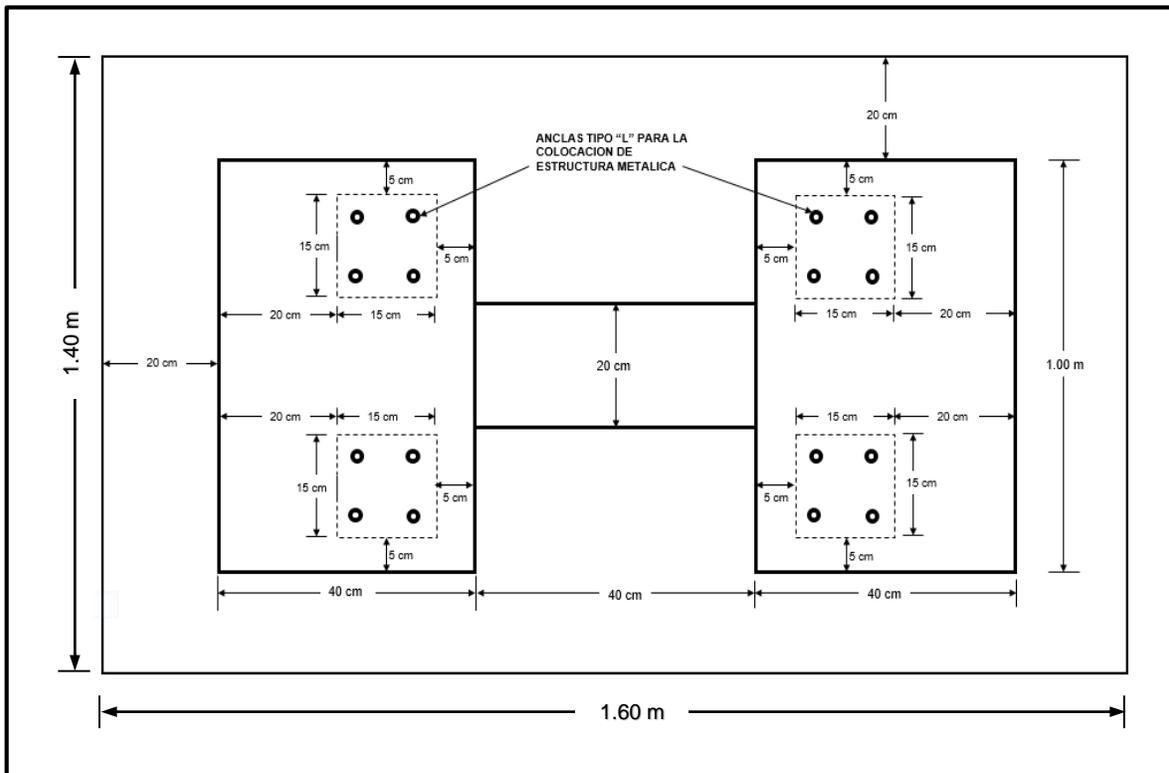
Vista planta de Cimentación para Estructura Mayor
